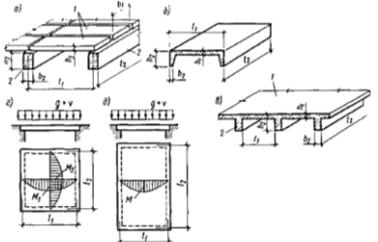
Конструкция изгибаемых железобетонных элементов: а — опорная плита; б — балочная плита; в — опорная плита с выносом; г — плита, опертая по контуру; д — балочная плита; е — плита с выносом
